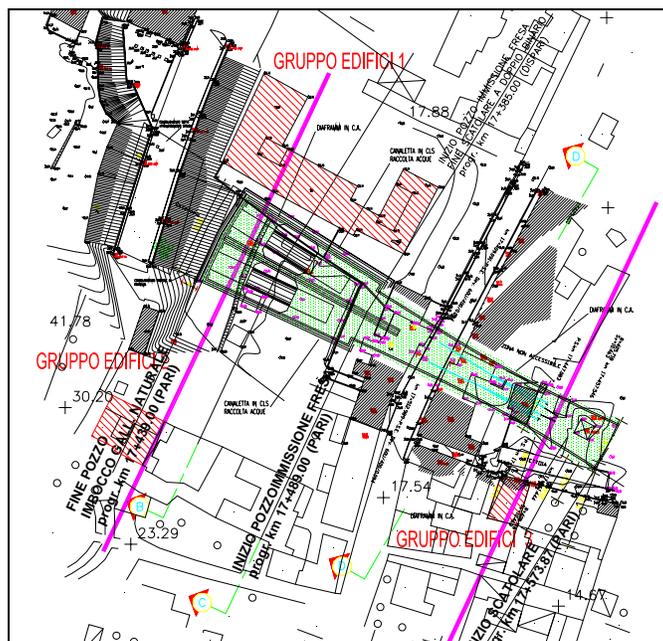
Stralcio planimetrico dell'imbocco della galleria Santa Cecilia con l'indicazione delle sezioni di analisi.
